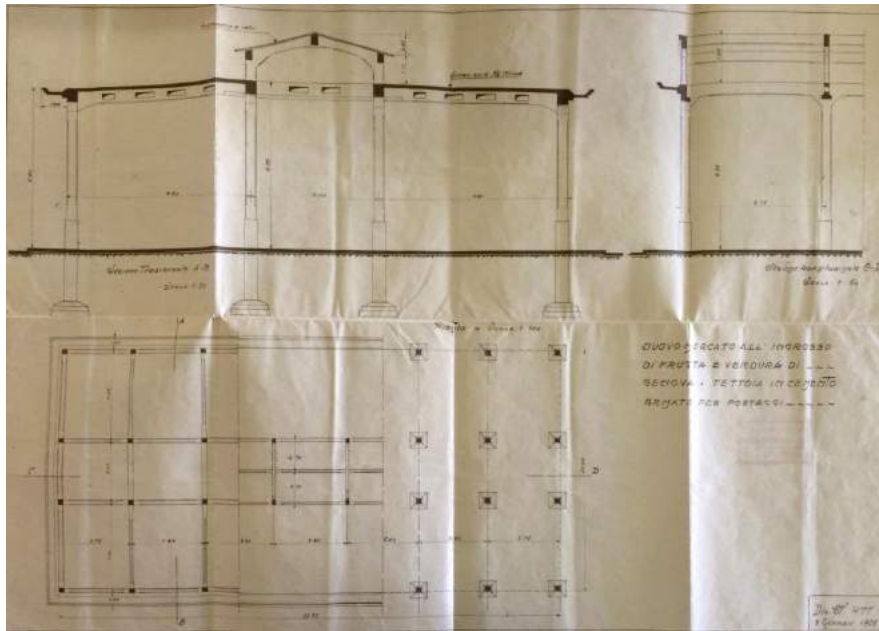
Presunto progetto prima tettoia (1926)-Archivio storico
